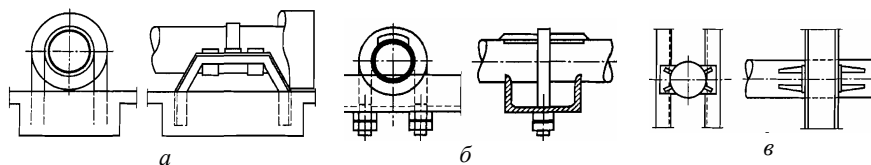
Неподвижные опоры: *а*) на фундаментах; *б*) на балке; *в*) на стойках
